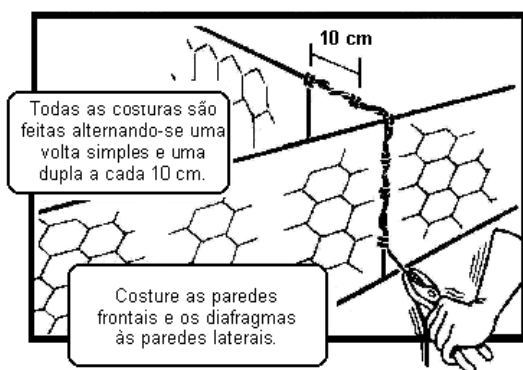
Amarração da parede longitudinal ao diafragma.
